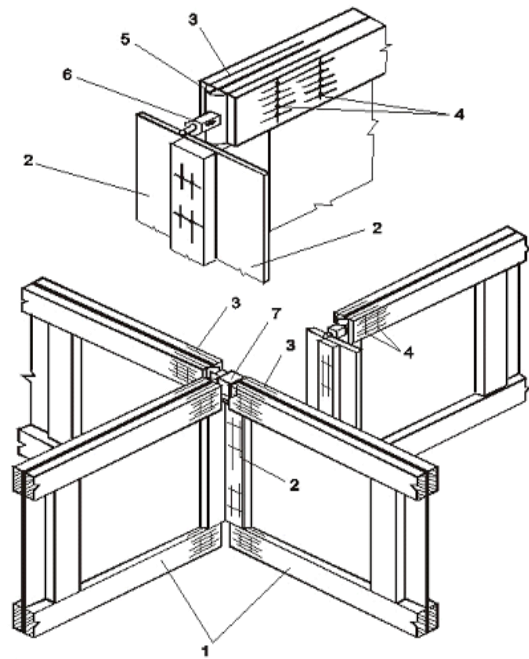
Перекрёстная система из клефанерных балок: 1 – балки; 2 – клефанерные накладки; 3 – U-образные стальные полосы; 4 – нагели; 5 – полуцилиндрический вкладыш; 6 – болт с муфтой; 7 – сердечник
